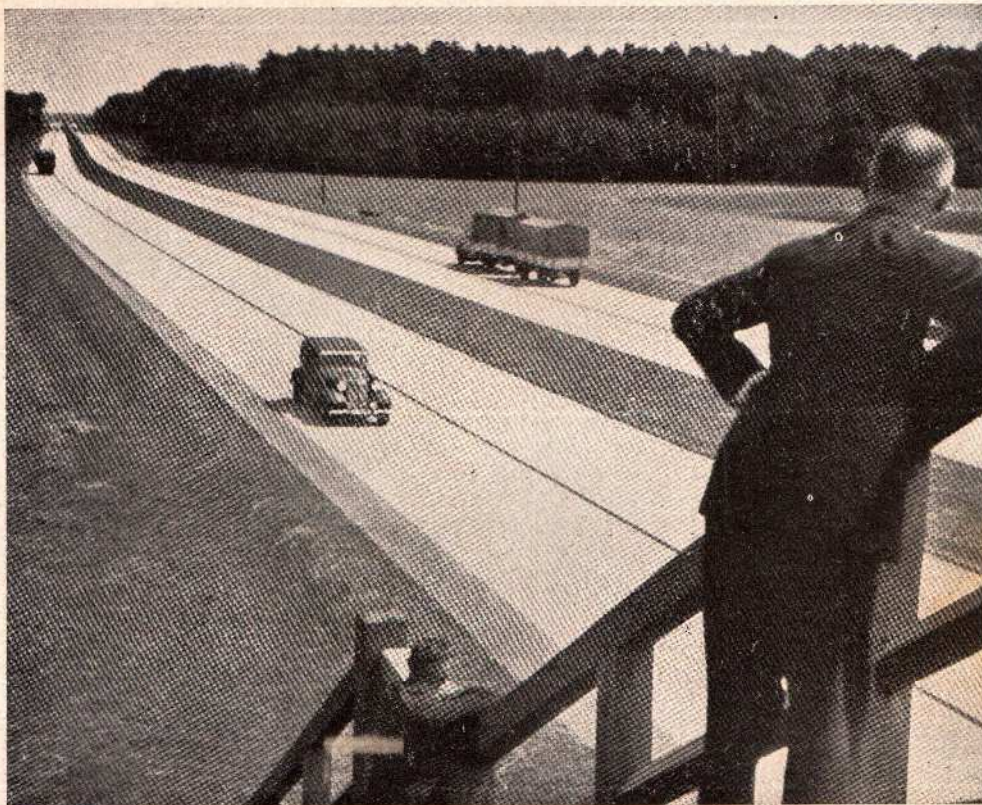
Auto-estrada com duas guias de 7,50 m de largura, porte central ajardinada com 5 m. e faixas lateraes de 0 m. 40 e 1 m. Construída com duas capas de concreto e dupla armadura metálica
